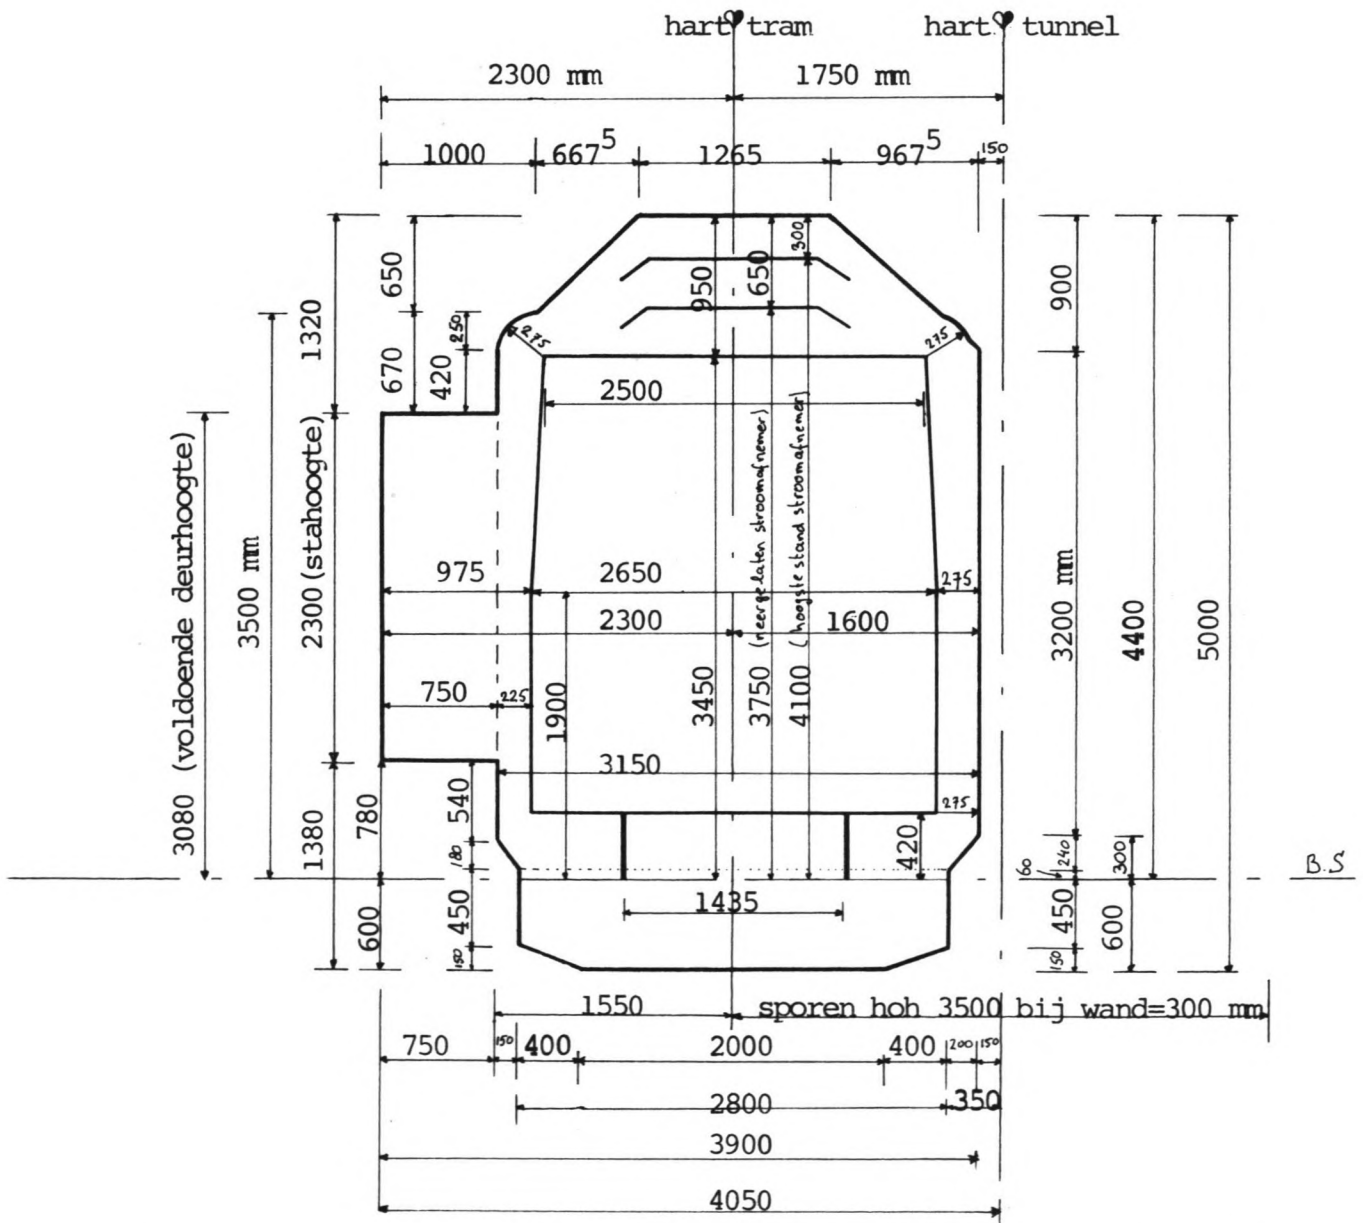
Vorm en afmetingen van minimale profiel van vrije ruimte voor tunnel met tussenwand en ballastbed
